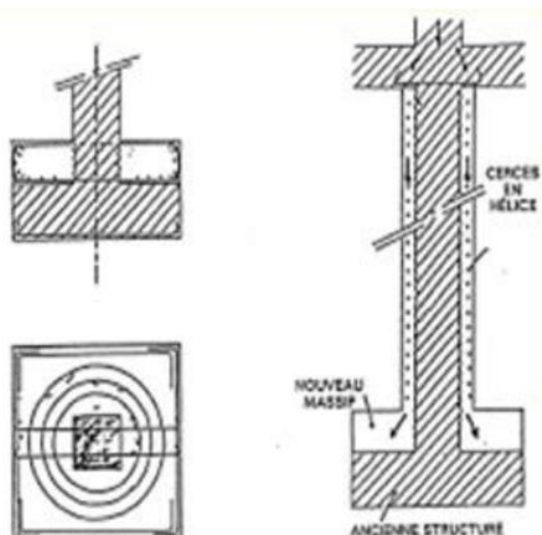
Renforcement de la fondation avec augmentation de l'épaisseur de la fondation sans augmentation de la surface [26].
